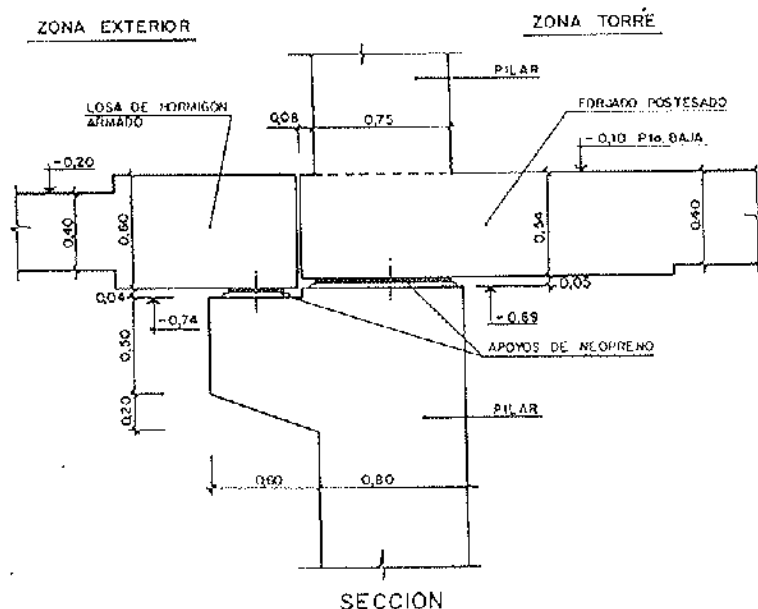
Detalle de la zona de apoyo de pilares de planta baja.
